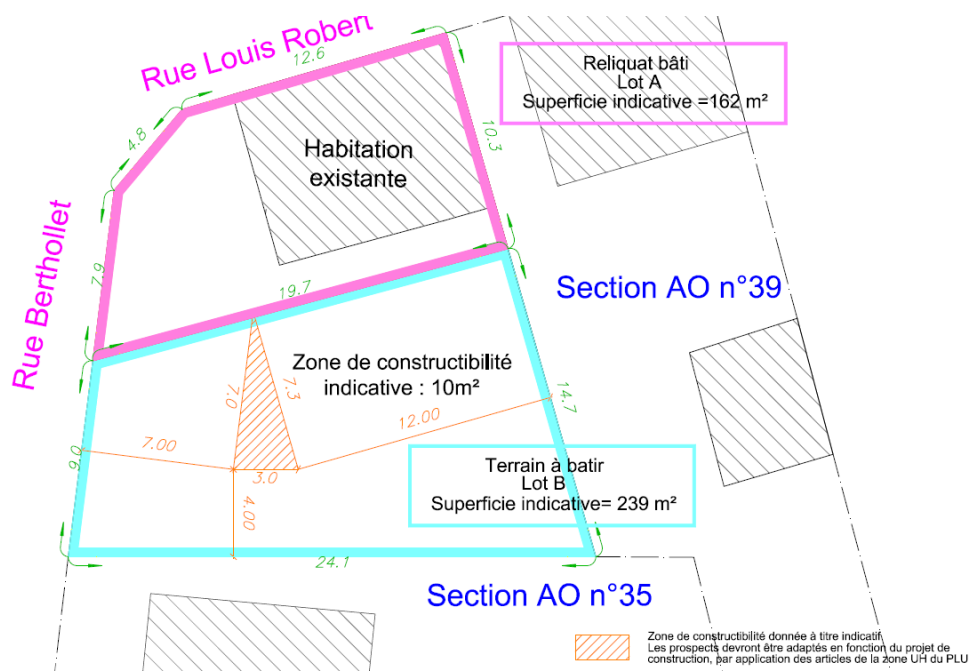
Plan projet avec la zone de constructibilité maximale
